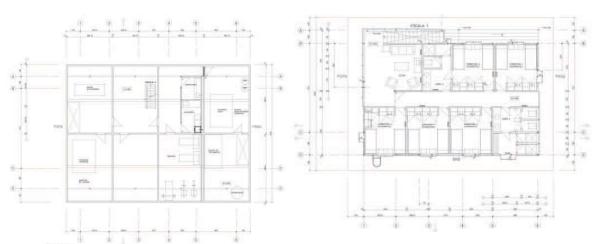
Planta casco estanco y segundo nivel. www.plataformaarquitectura.cl
